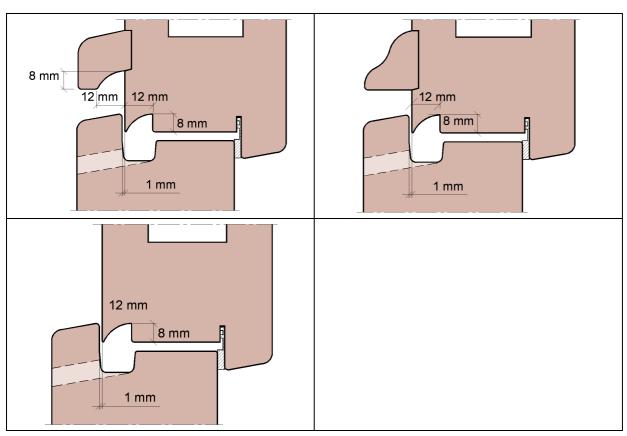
Exemples de dispositif d'arrêt d'eau efficace
